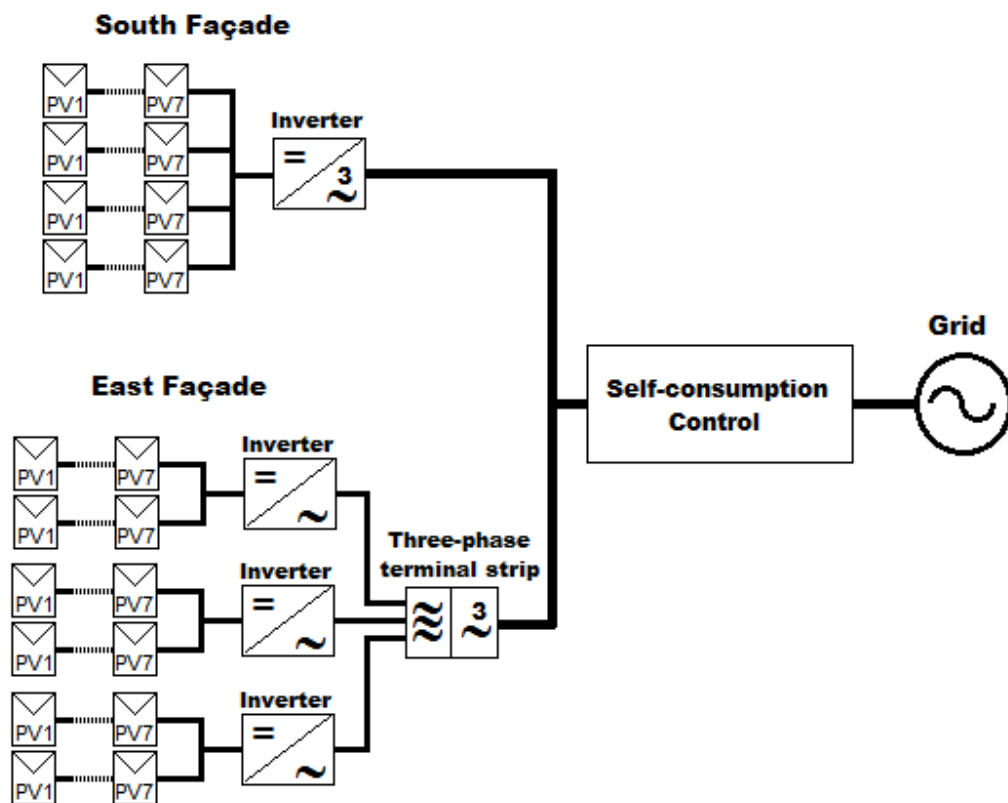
Diagrama módulos BIPV en fachadas Sur y Este
